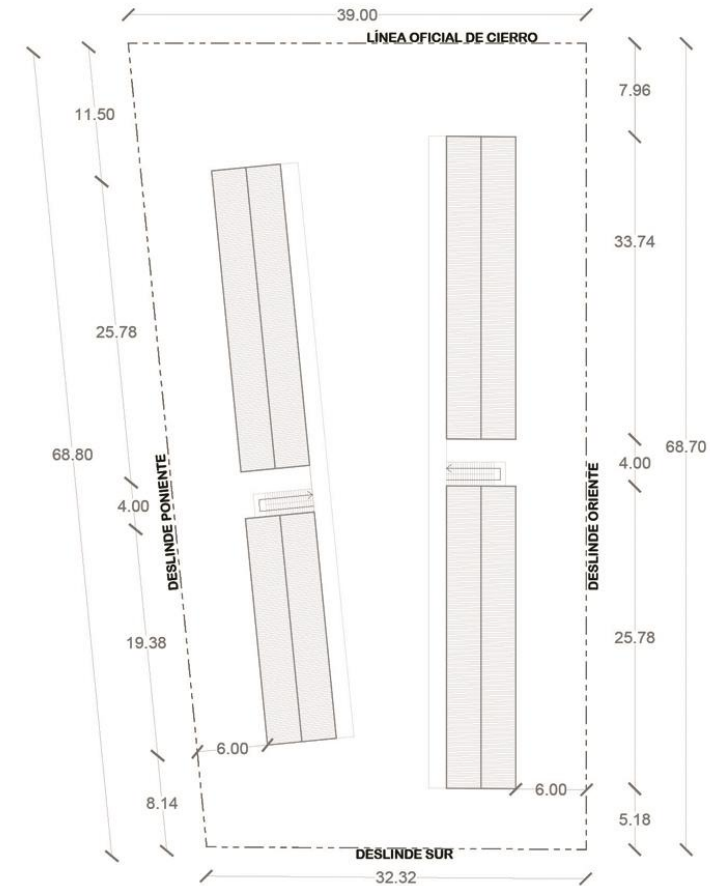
Planta del Conjunto. Fuente: Elaboración propia en base Archivo DOM 1985.
